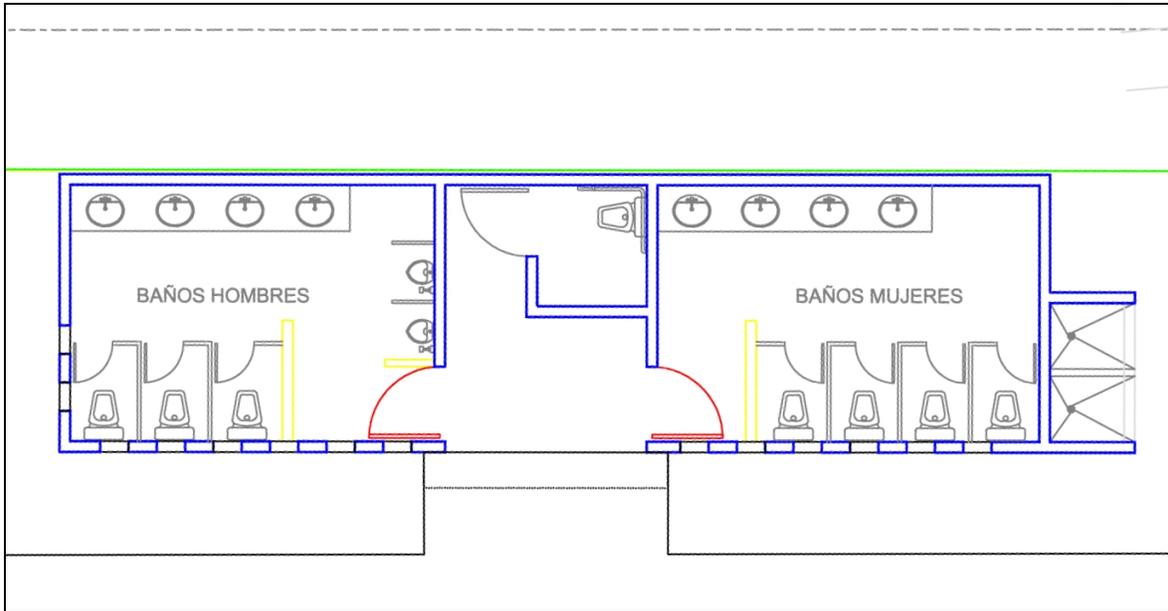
Planta del módulo de servicios, con sanitarios y dos regaderas en el exterior.
